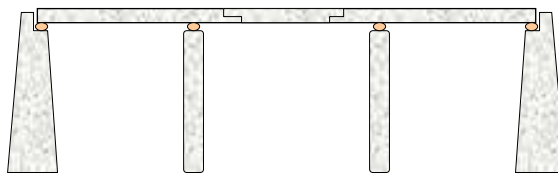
Puente Isostático continuo tipo Gerbert de sección constante
